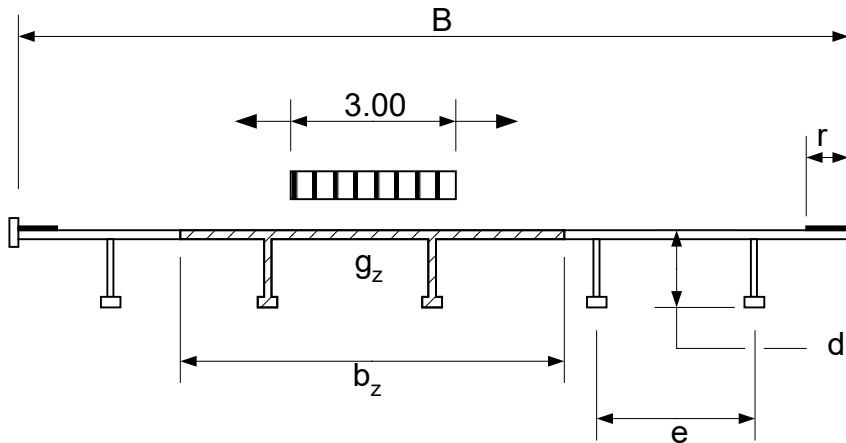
Poutre non rigide à la torsion (par ex. sections à poutre en T, section en auge).
